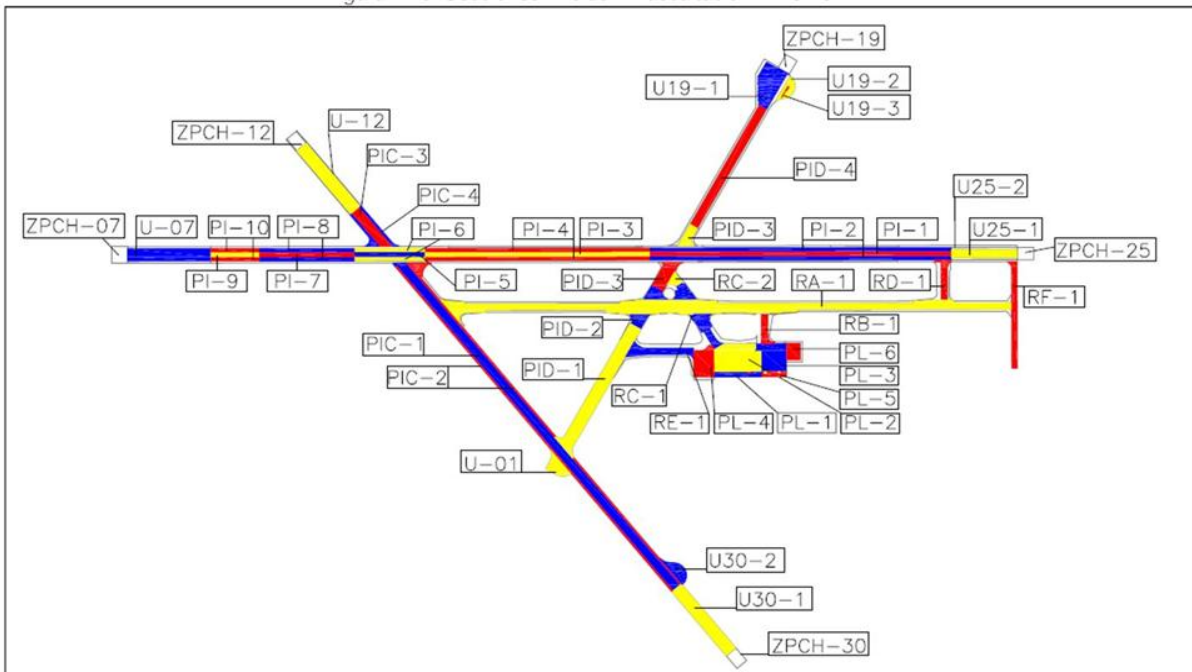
Plano esquemático secciones Aeropuerto Presidente Carlos Ibáñez del Campo.
